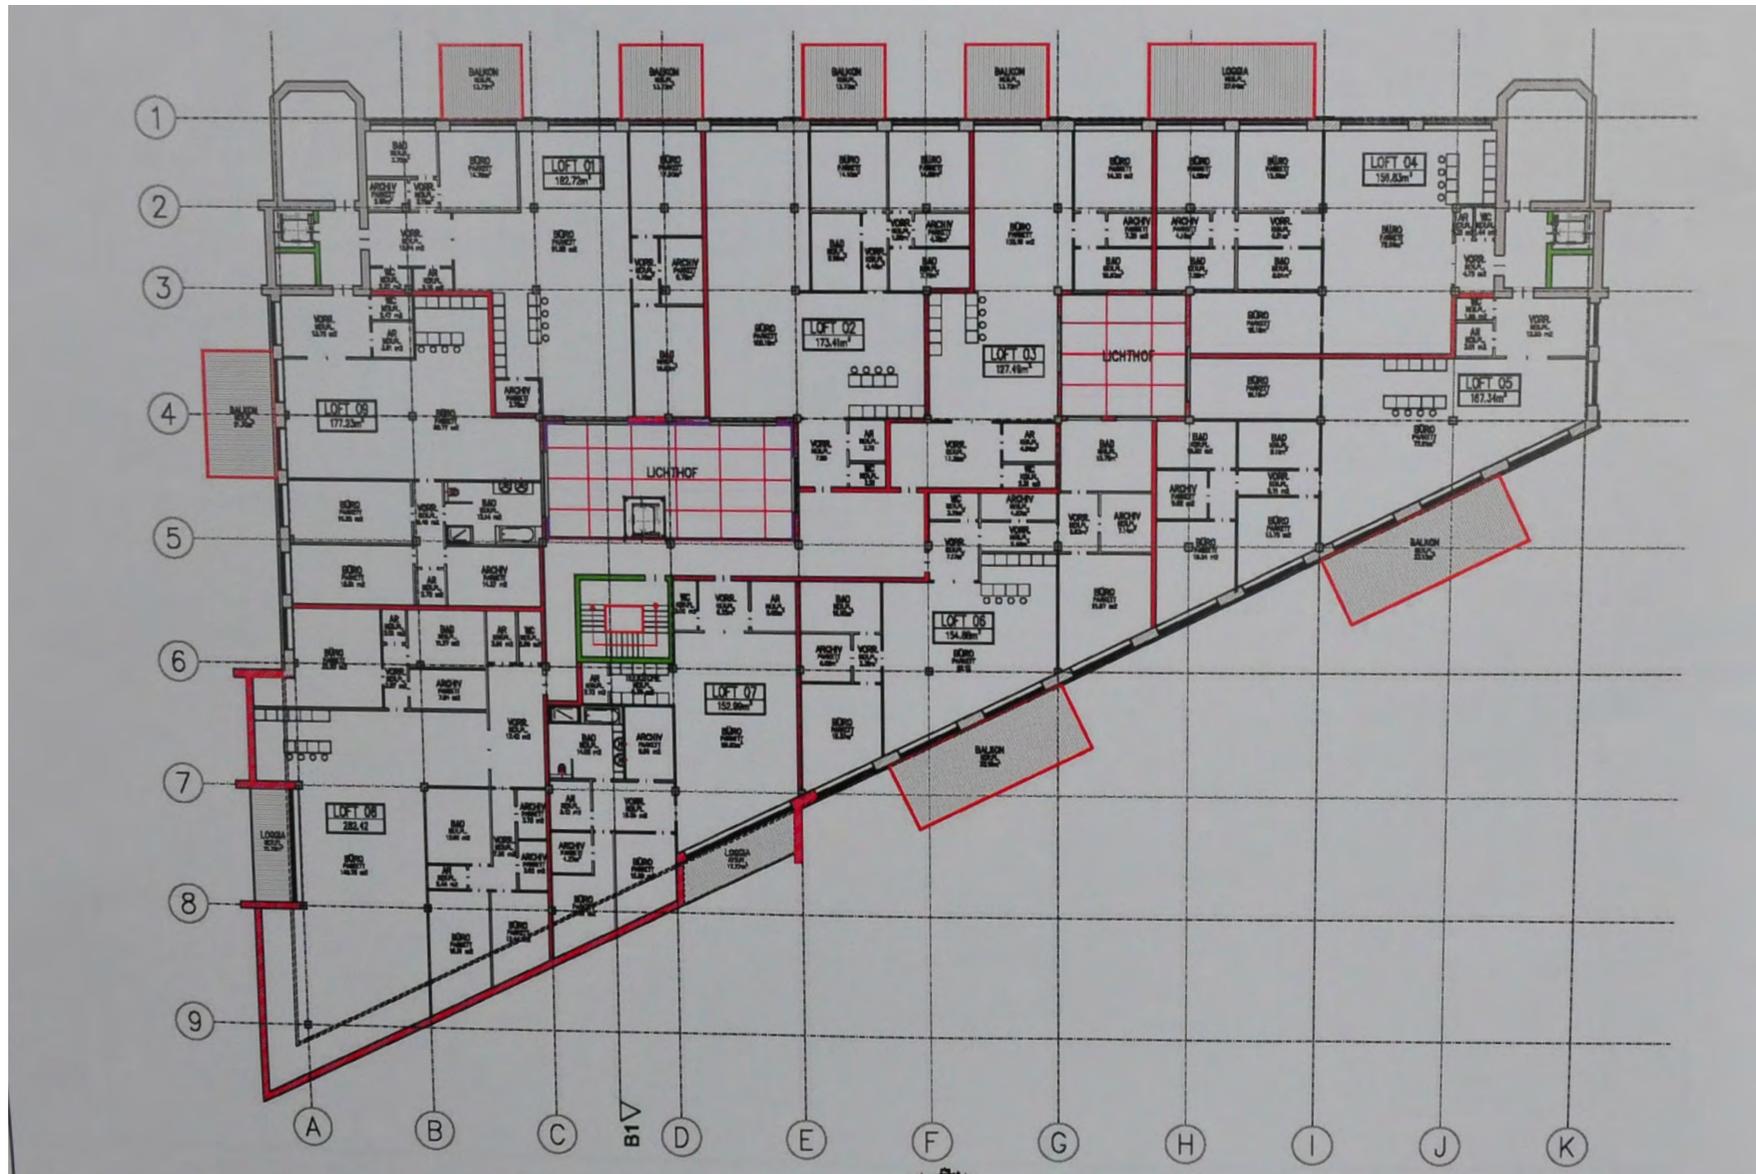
Grundriss des dritten OberGeschoß des Maschinenmagazins mit Balkonen, eingezogenen Wänden und Lichthöfen
